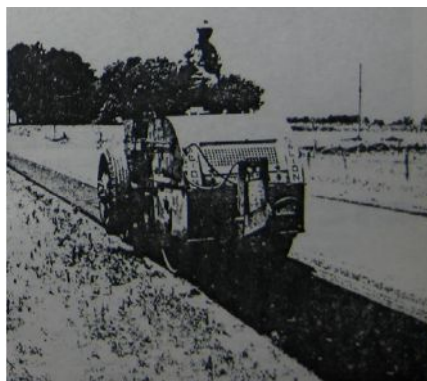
Extendiendo el material asfáltico mezclado en planta en caliente sobre un borde asentado
